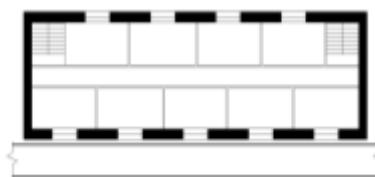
Не вірне трактування вимог. Громадська чотирьохповерхова будівля (гуртожиток), житловий п'ятиповерховий будинок з влаштуванням квартир, приміщень орієнтованих на дві повздовжні сторони будівлі.
